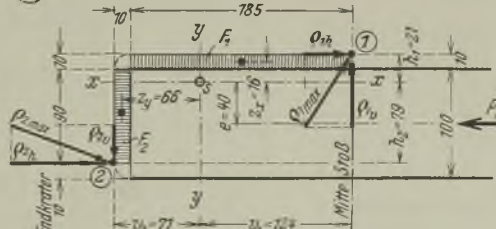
Biegeester Stoß eines IP 55 mittels voller Stumpfschweißung, Außen- und Innenflanschaschen, sowie Steglaschen.
